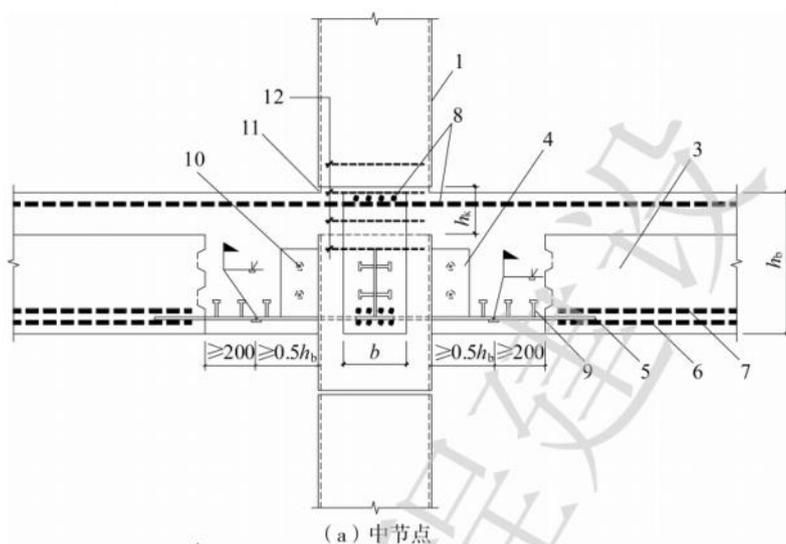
预制混凝土叠合梁-钢管约束混凝土柱框架用
